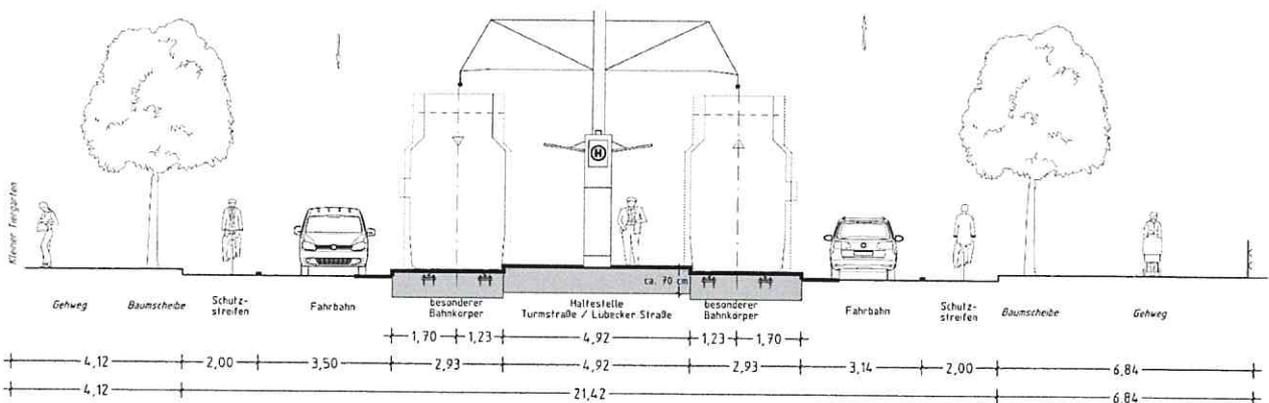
Querprofil 4.1 Turmstraße, Haltestelle Turmstraße/Lübecker Straße (Blickrichtung West)
